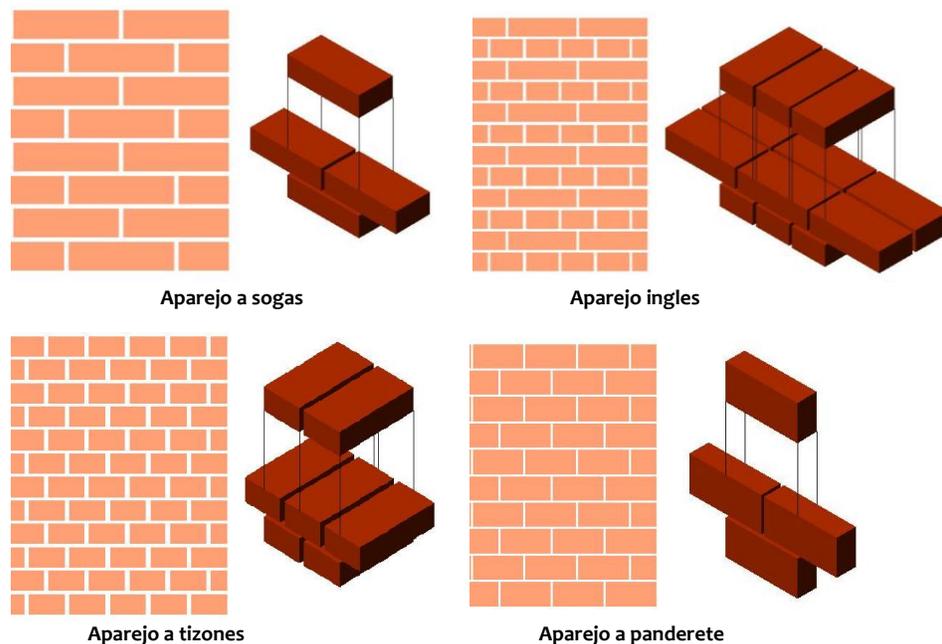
Tipos de colocación de ladrillo para la construcción de muros.
